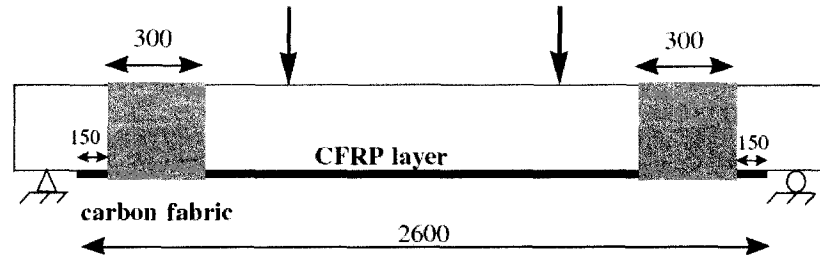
Renforcement d'ancrage par des bandes larges en composite – Poutre F (Buyle-Bodin et David 2004)
